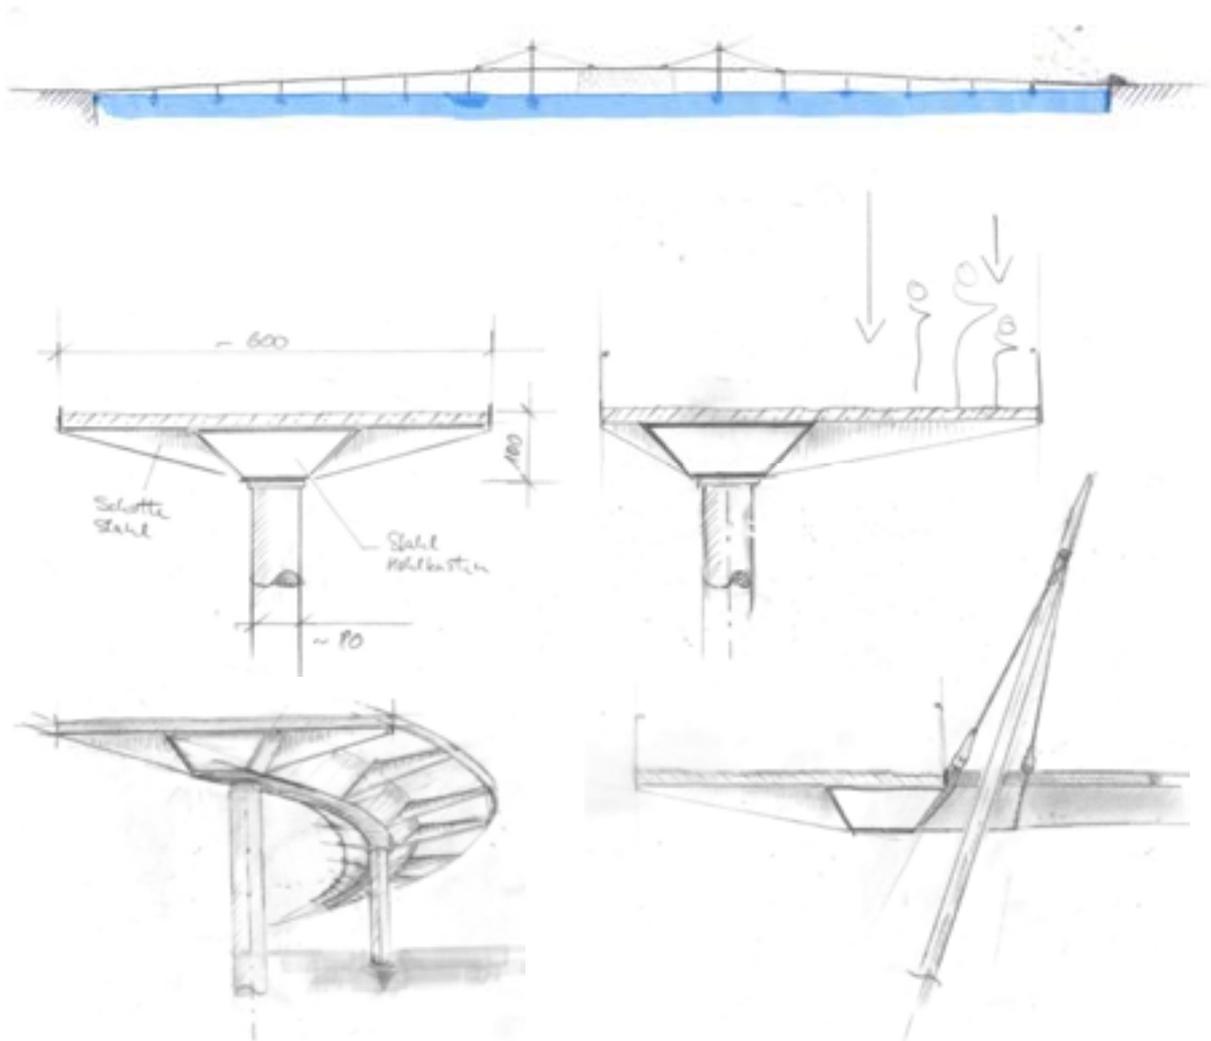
Entwurf und Konstruktion der Vorzugsvariante
